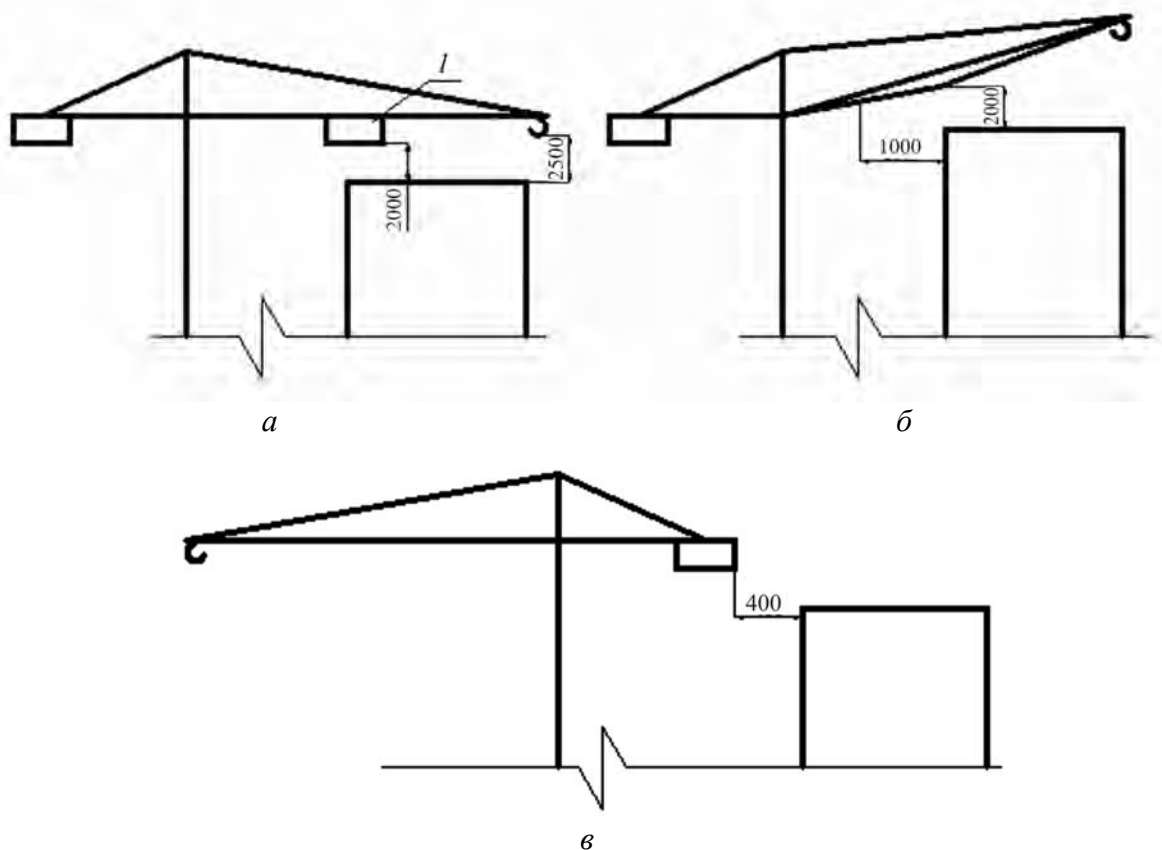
Минимально допустимые расстояния от конструкций монтажных механизмов до строящегося здания: а — от крюка или противовеса до монтажного горизонта; б — от стрелы крана до здания; в — от противовеса крана до здания; l — противовес над монтажным горизонтом при повороте крана
